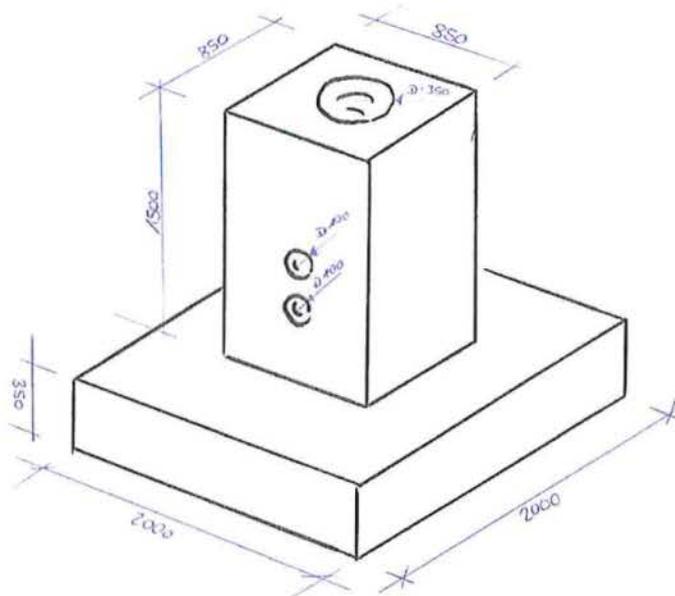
Betonfertigteilfundament für Beleuchtungsmasten mit Lichtpunkthöhe 16 m
